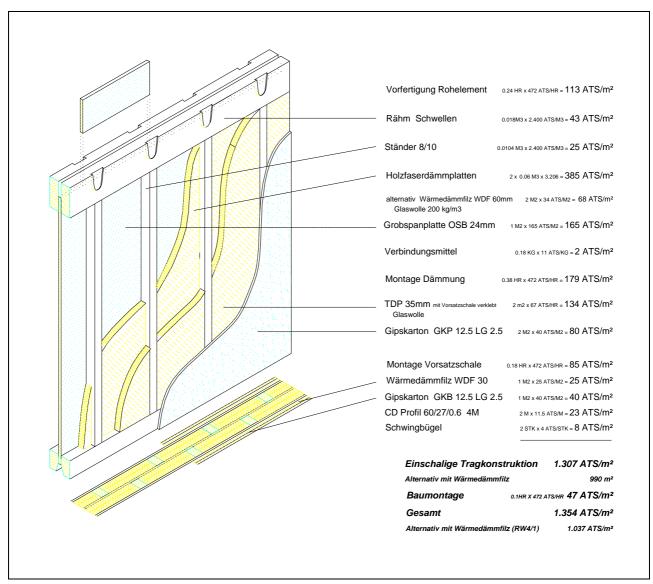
Einschalige Holzrahmenwand mit mittiger Scheibe (RW4)
